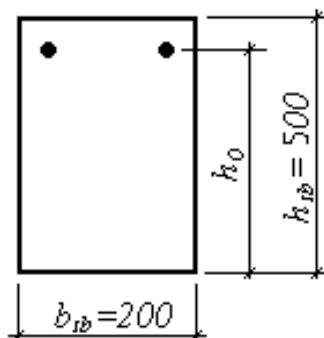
Розрахунковий переріз другорядної балки на опорах
